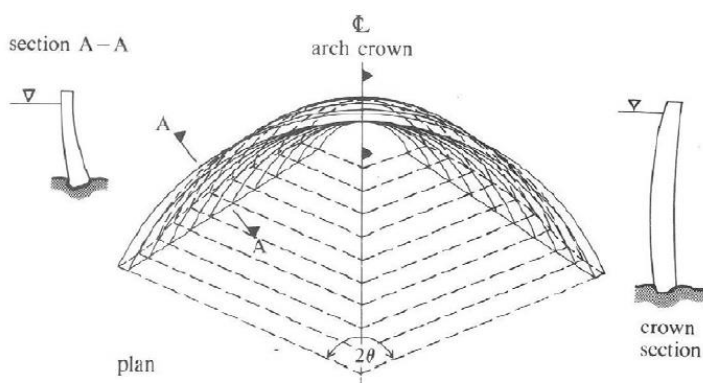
Presa arco con perfil de ángulo constante. Planta y secciones. (Fuente: CASTILLO [16])
